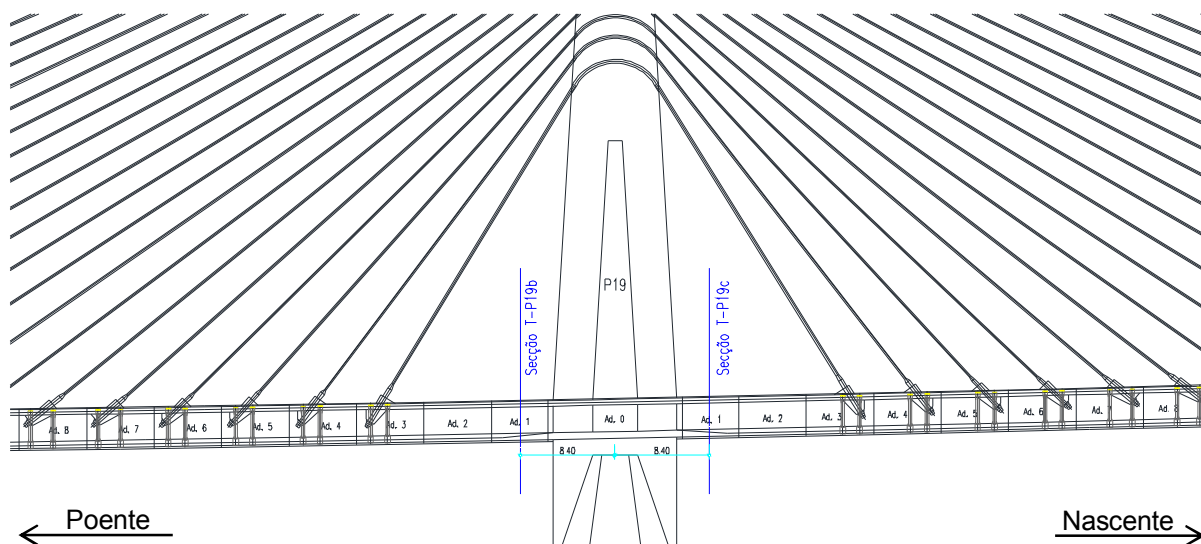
Localização das das secções instrumentadas junto do mastro 19.
